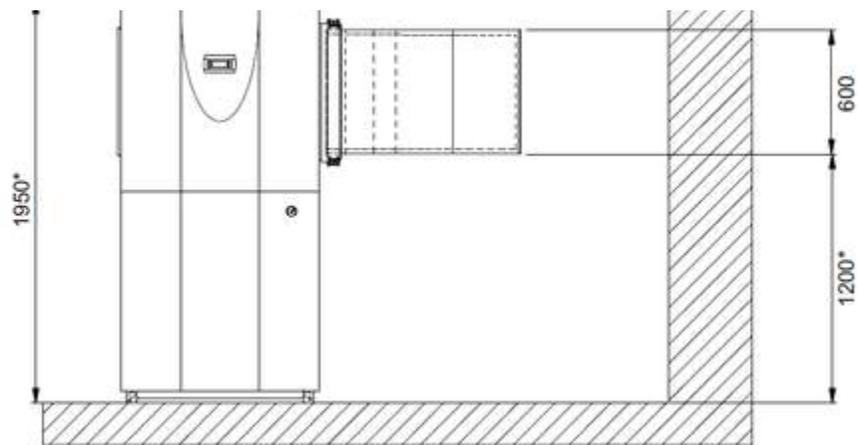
Vista frontale - LIK 12TU (installazione a parete con canale aria lato mandata)
